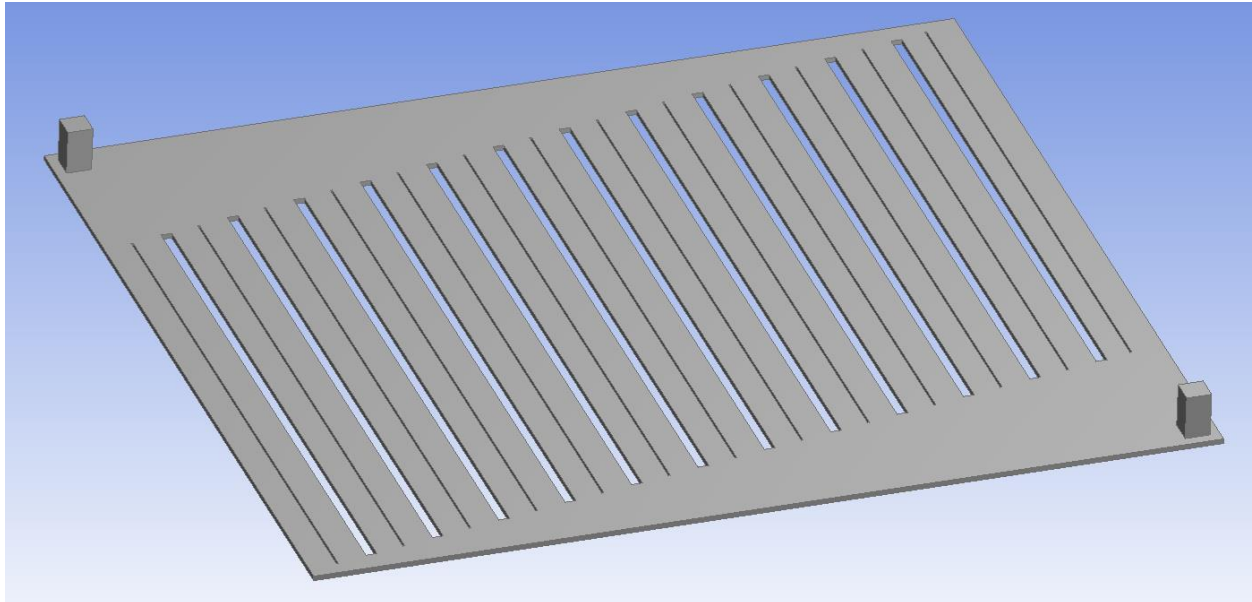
Cubierta Plana 2 con Canales 0,3 m
